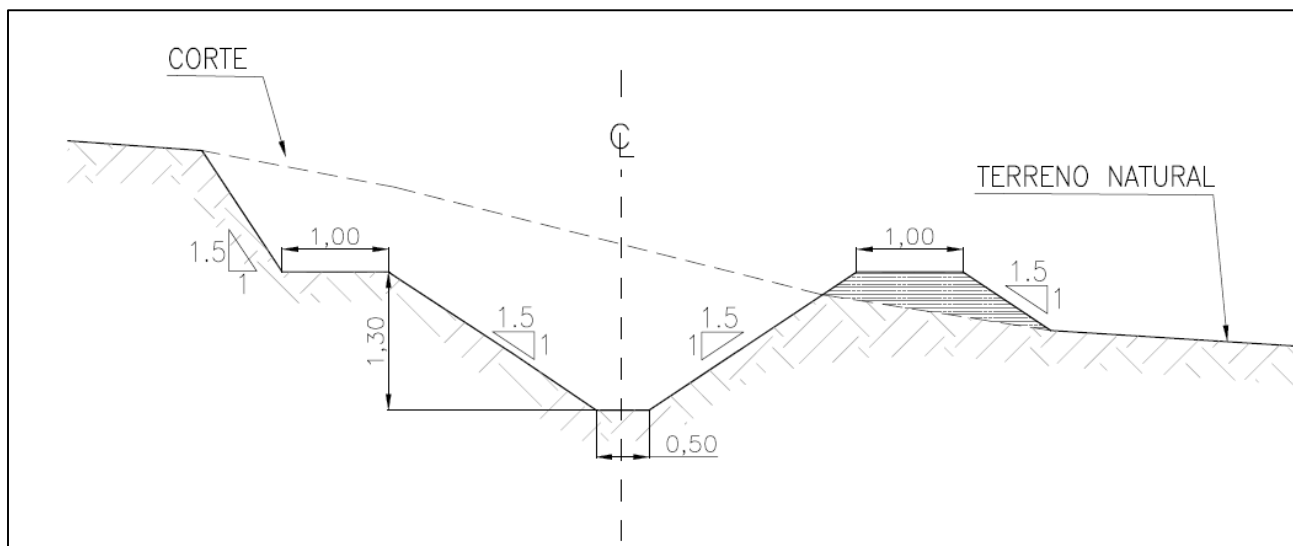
Canal de Desvío – Sección Transversal Típica
